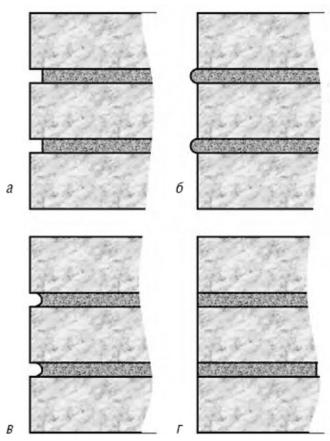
Расшивка швов кладки: a -впустошовку; б -валиком; в -выкружкой; ε -вподрезку
